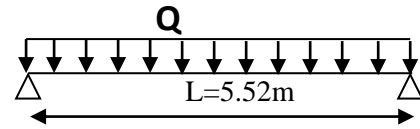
; Poutre principale de rive pour plancher terrasse
